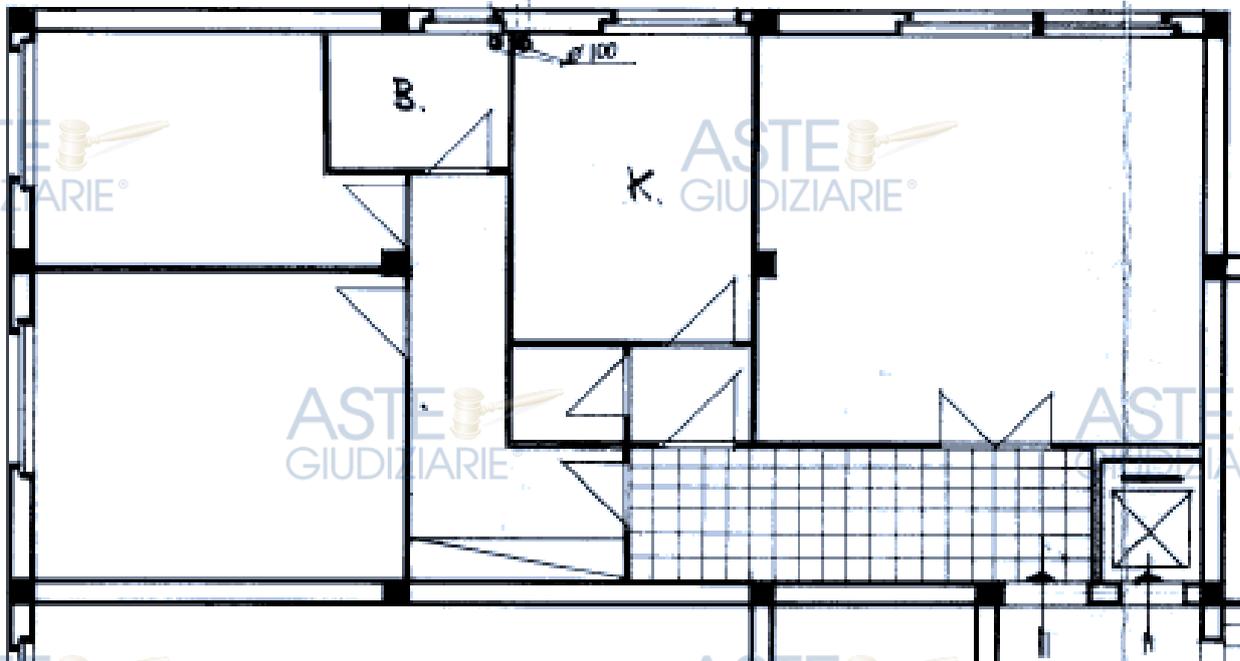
Raffronto planimetria stato di fatto e planimetria progettuale - BENE A - foglio 101, particella 163 subalterno 3
